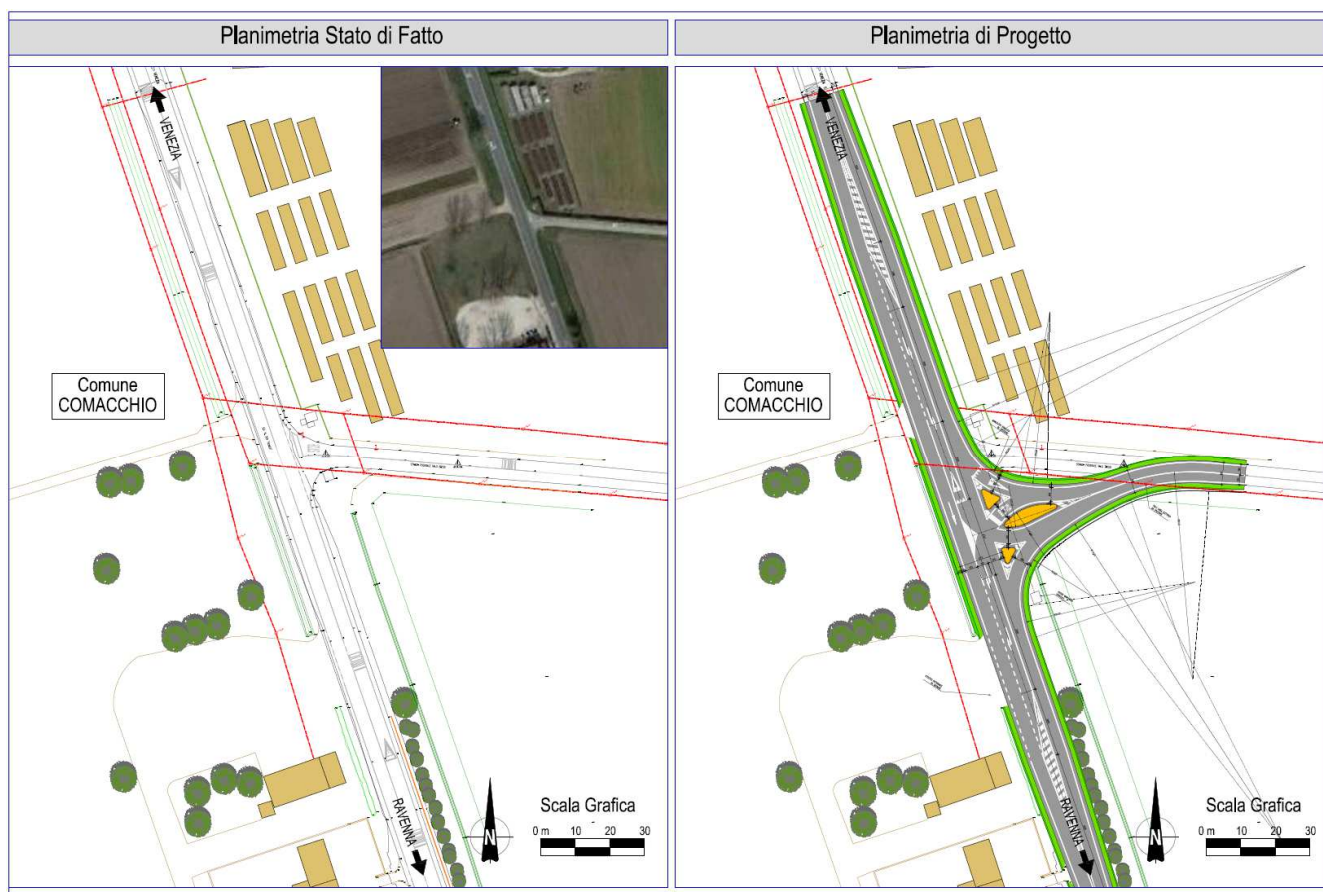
Intervento n° 14 – Planimetria Stato di fatto - Progetto
